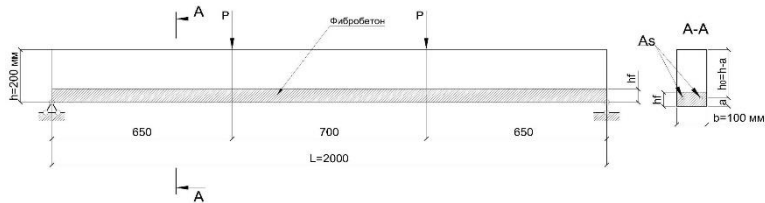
Зональное армирование фиброй в нижней грани балки на высоту h_f
